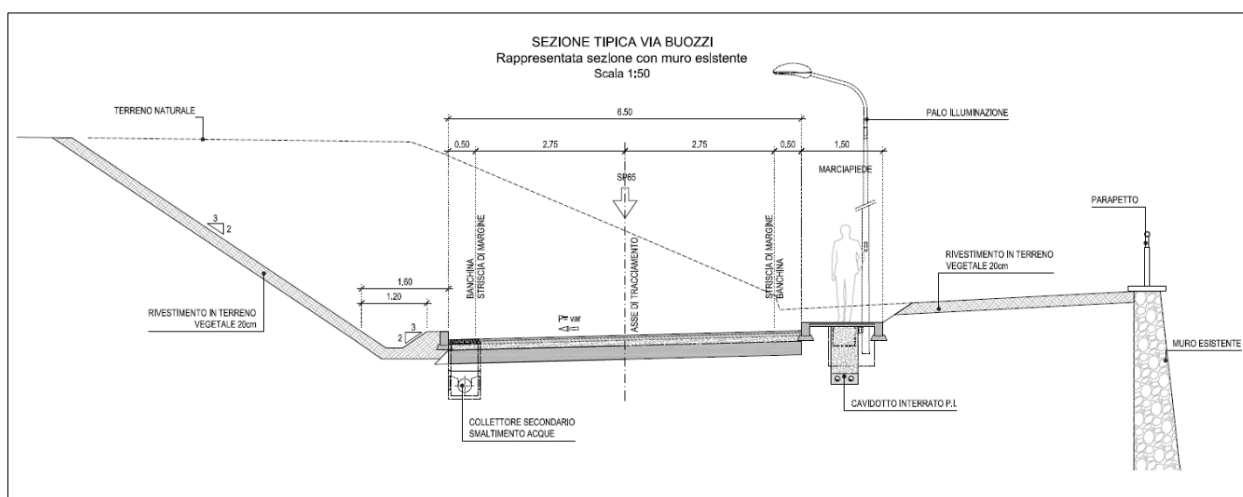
sezione trasversale tipica deviazione via Buozzi.
